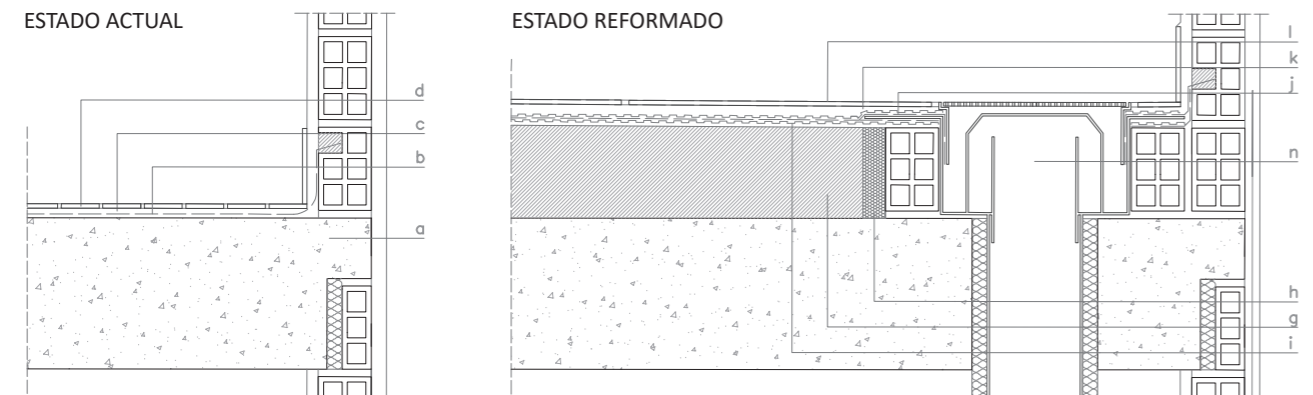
Detalle constructivo. Impermeabilización terraza comunitaria en encuentro con sumidero. [Tabla 2]
